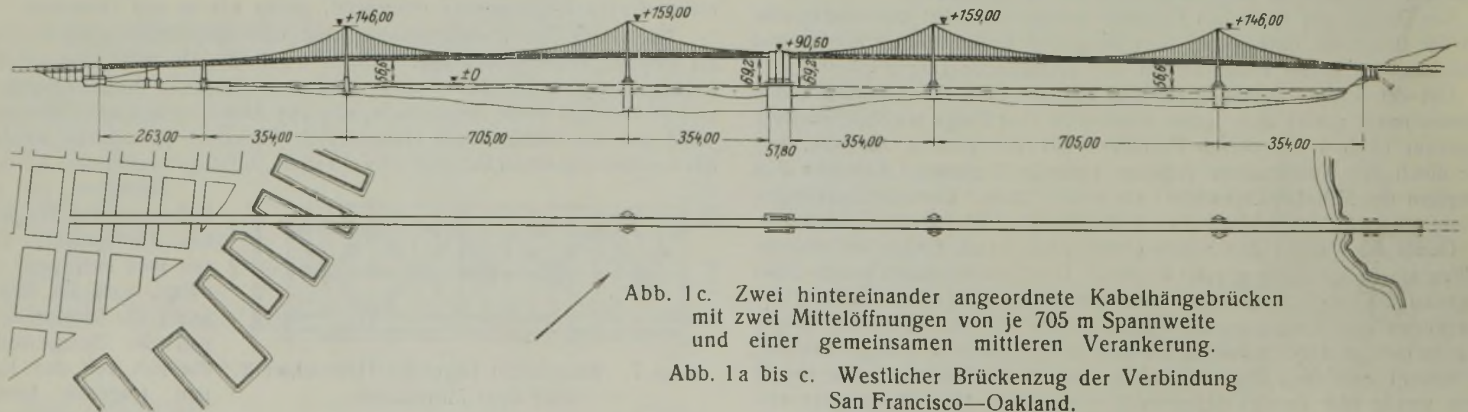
Zwei hintereinander angeordnete Kabelhängebrücken mit zwei Mittelöffnungen von je 705 m Spannweite und einer gemeinsamen mittleren Verankerung.
